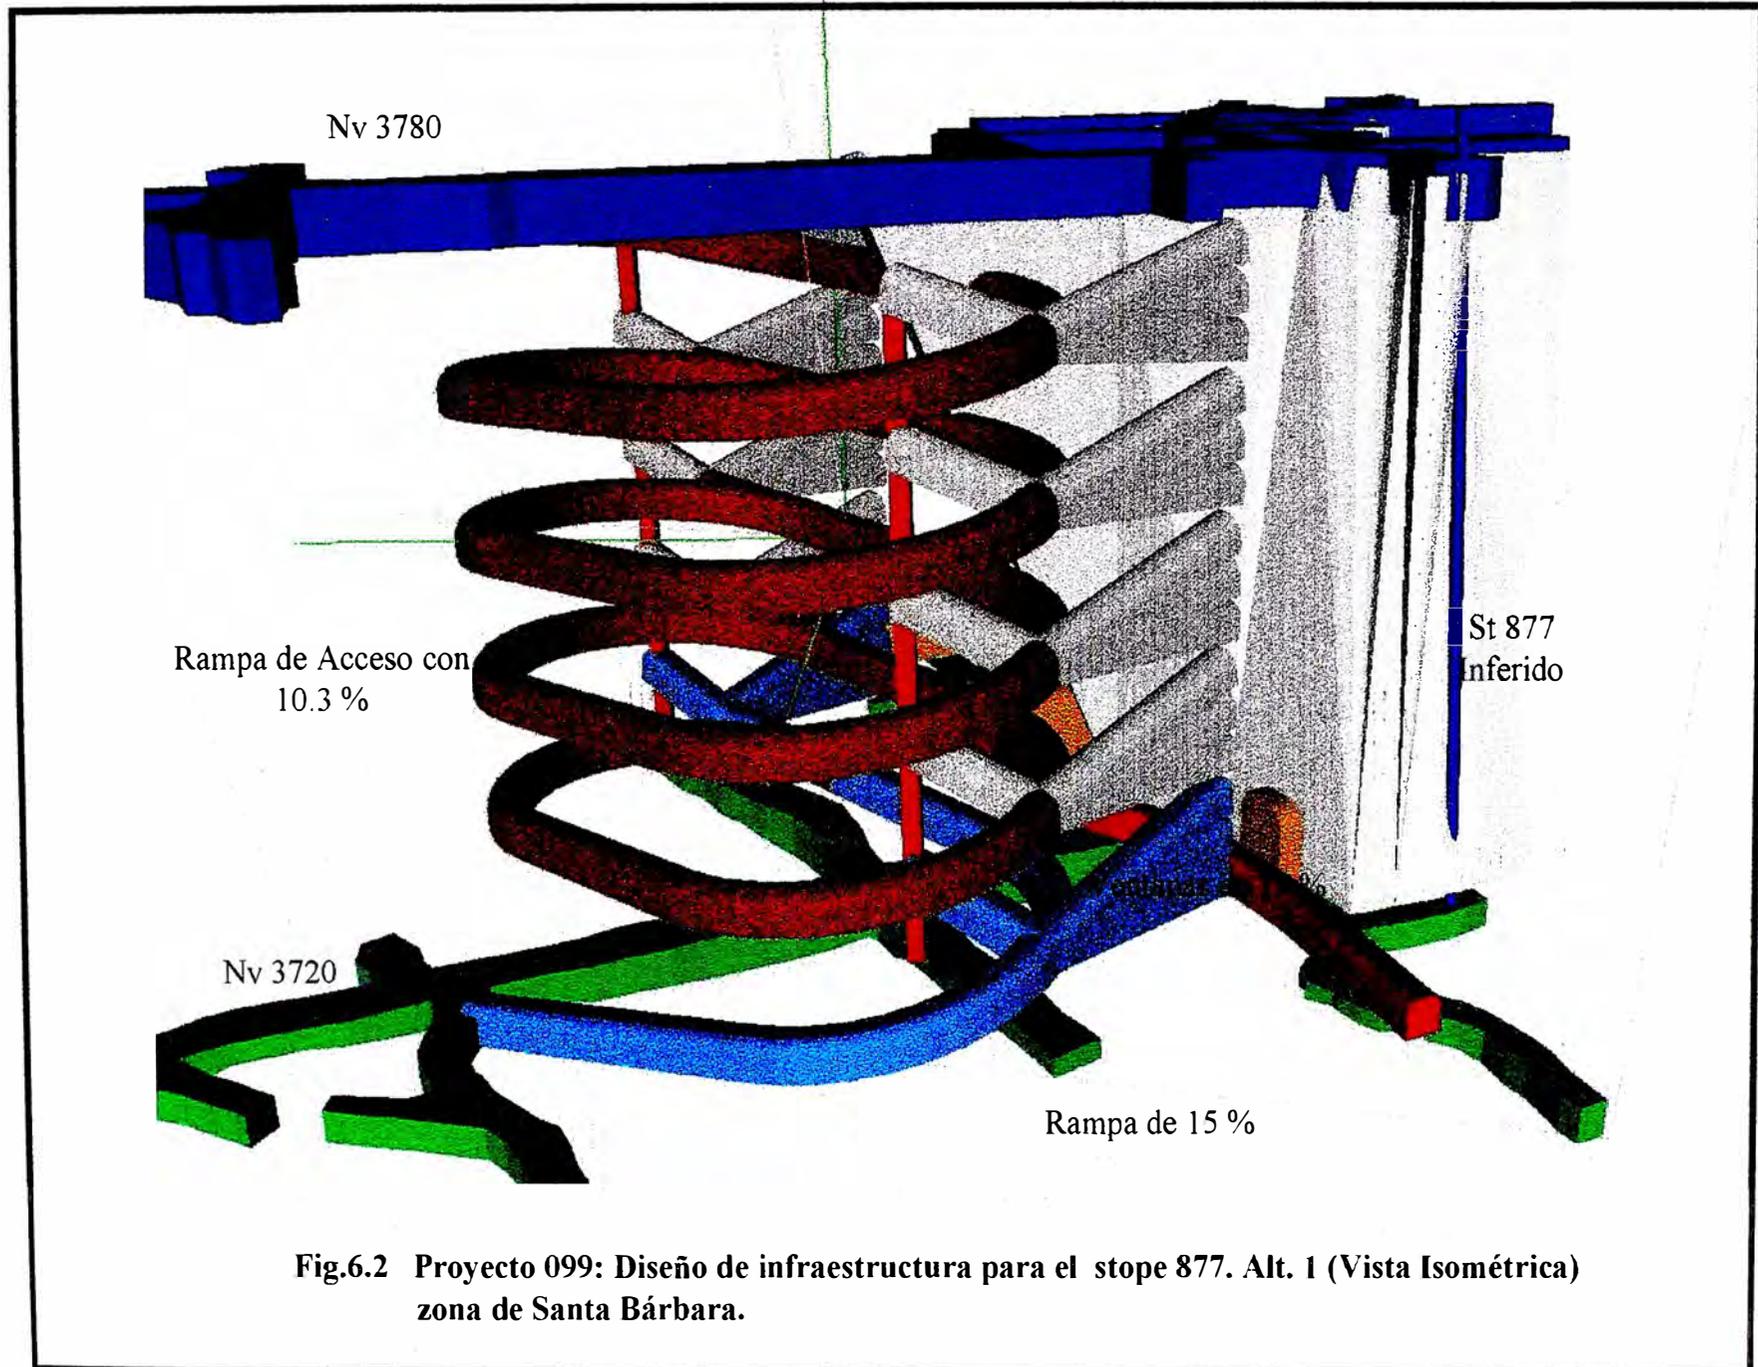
Proyecto 099: Diseño de infraestructura para el stope 877. Alt. 1 (Vista Isométrica) zona de Santa Bárbara.
